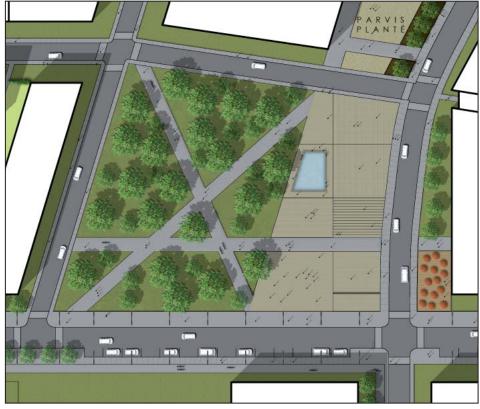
Plan schématique de la place centrale du nouveau quartier.
